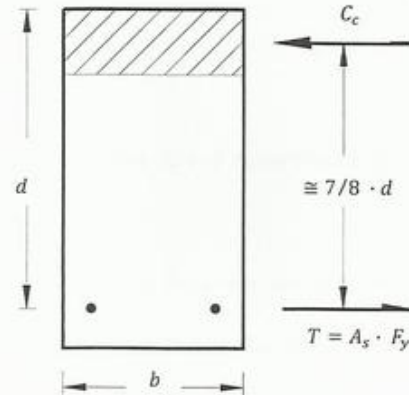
Sección rectangular. Brazo de palanca aproximado para secciones que fallan por tracción
